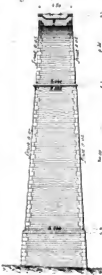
Viaduc de la Geyre. Ensemble à 0<sup>m</sup>001
